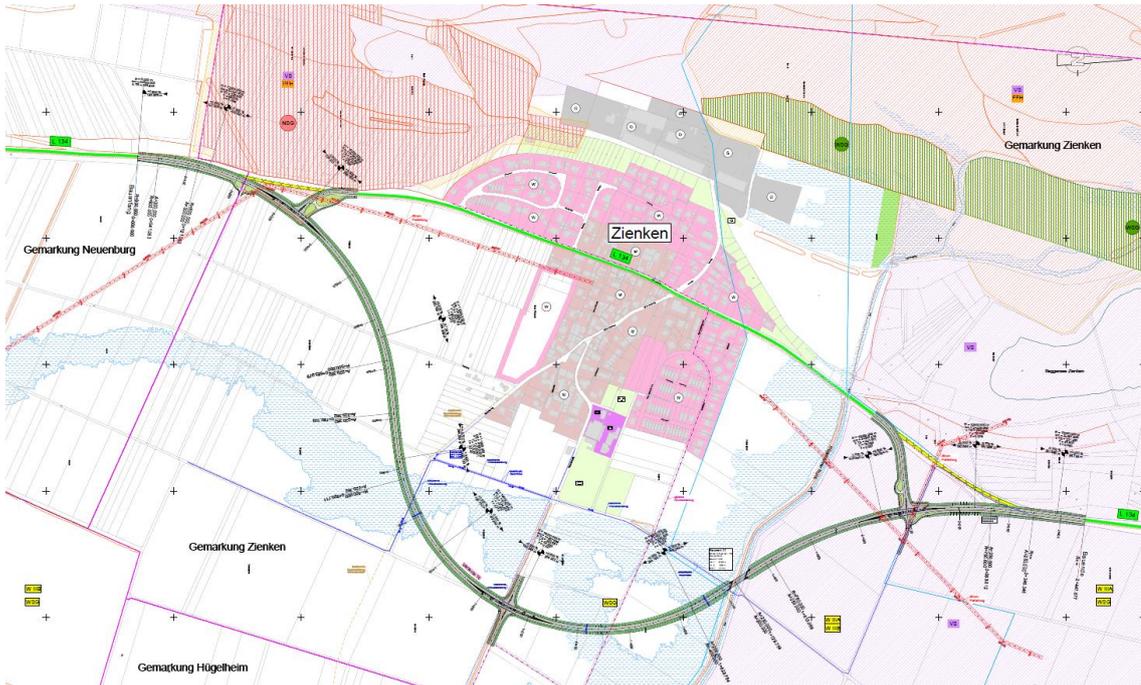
Lageplan Variante 1b (vgl. Unterlage Nr. U 5_2)
